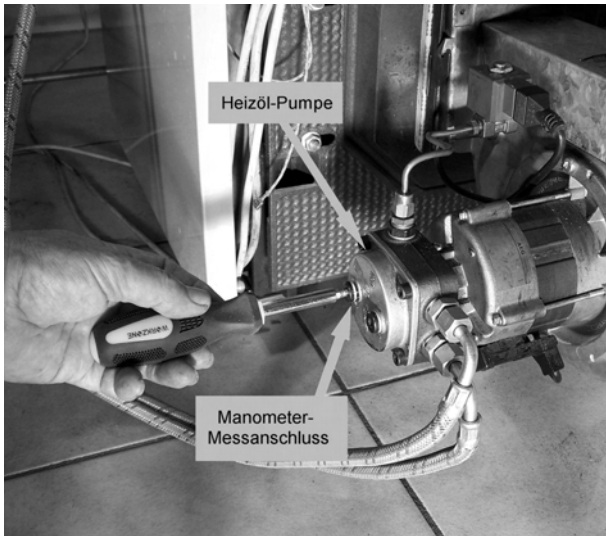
In das Pumpen-Messgewinde für die Druckmessung wird das Mess-Manometer eingeschraubt.
